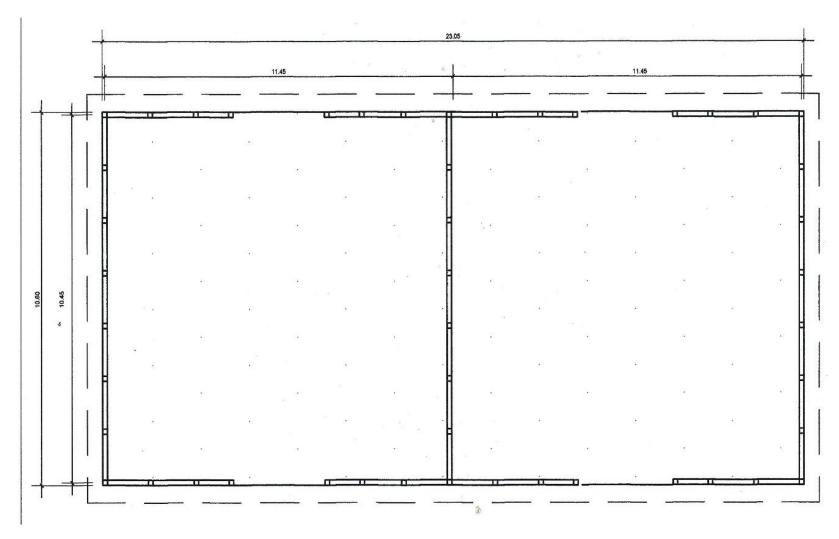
Plano amueblado de las cámaras de compost de la fase A y B.
